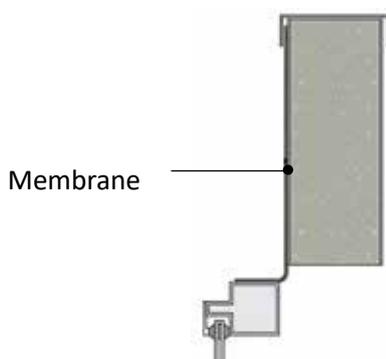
Joint à 1 étage (principe d'un raccordement d'acrotère)
